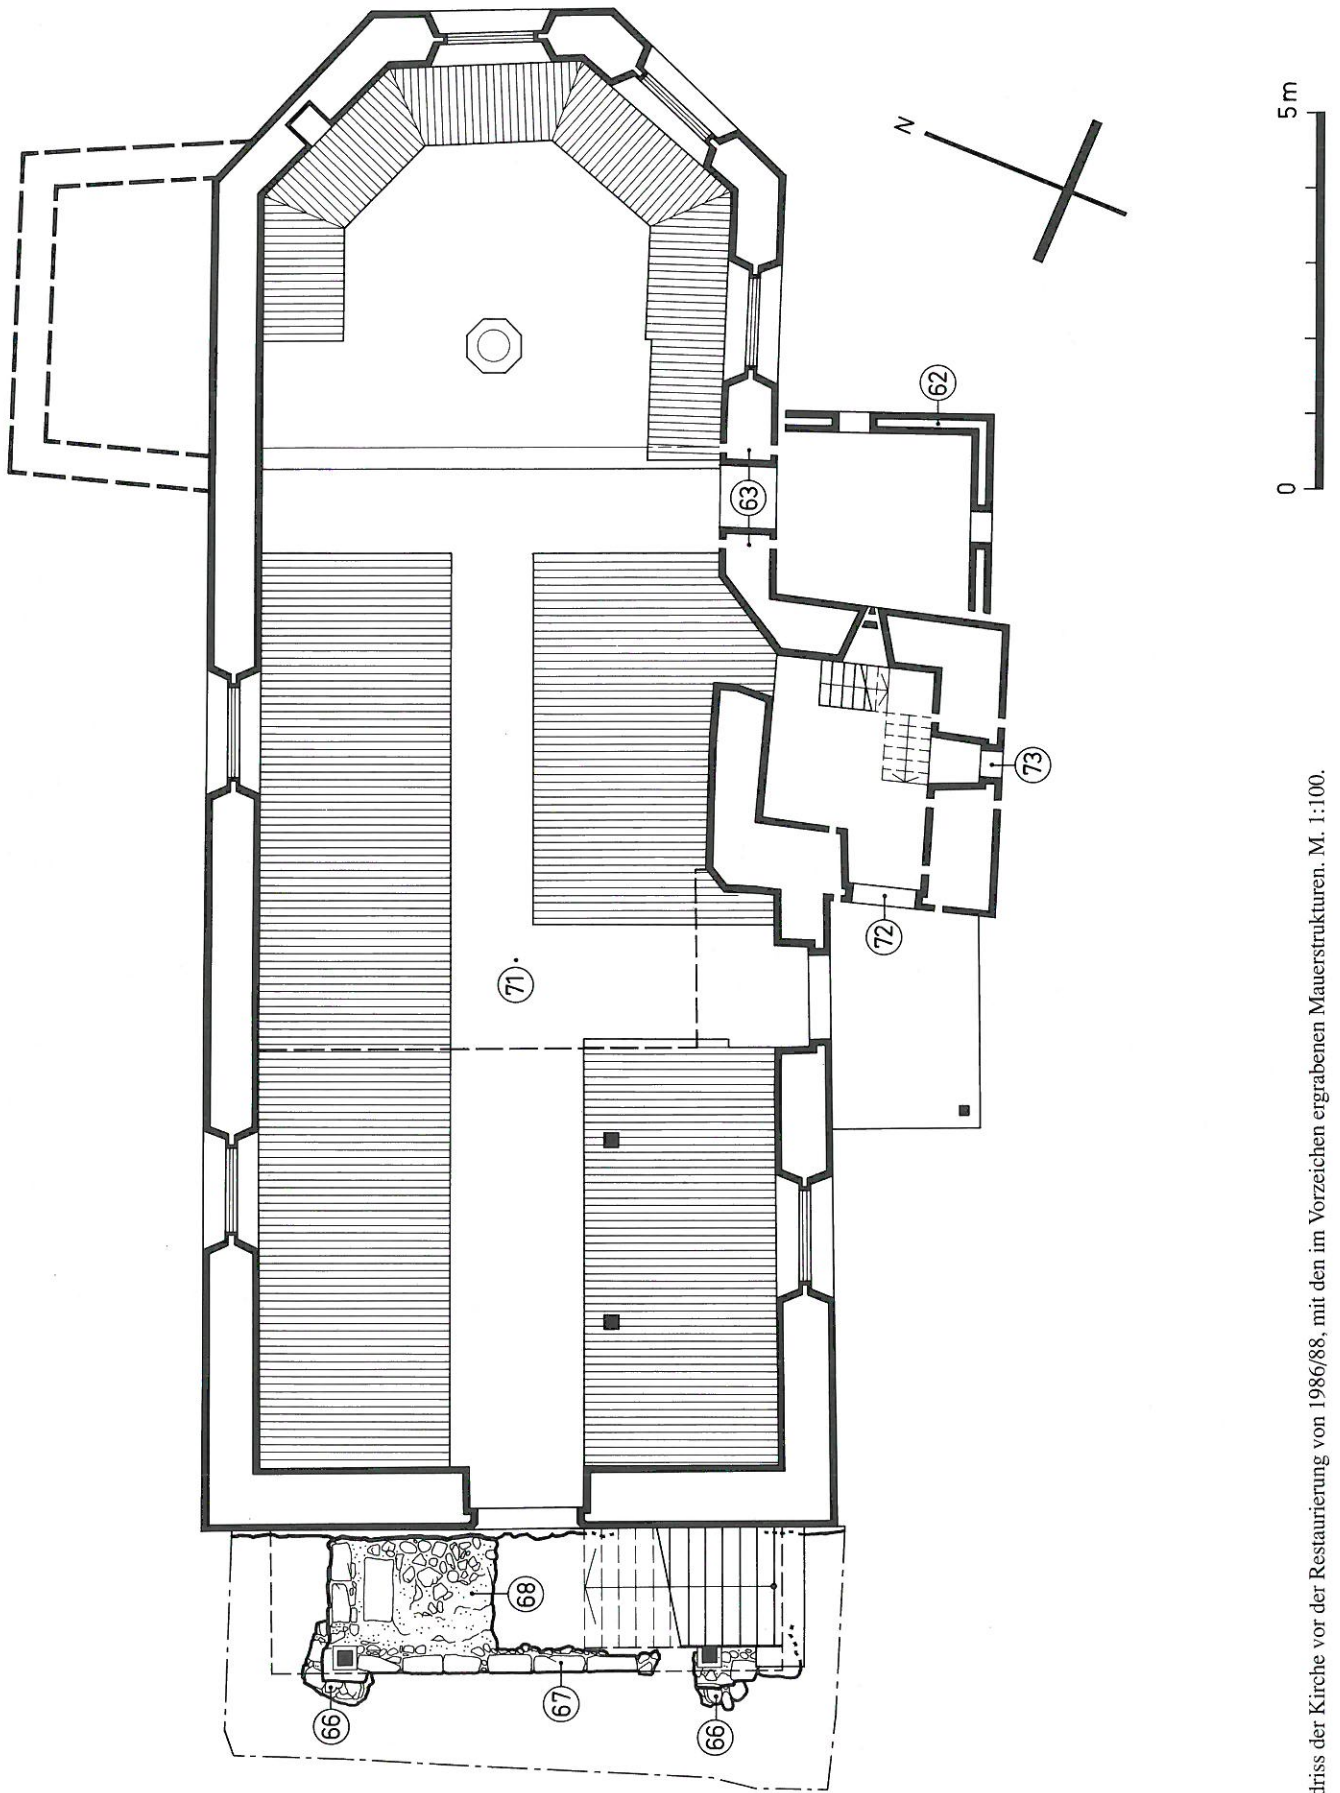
Grundriss der Kirche vor der Restaurierung von 1986/88, mit den im Vorzeichen ergrabenen Mauerstrukturen. M. 1:100.
